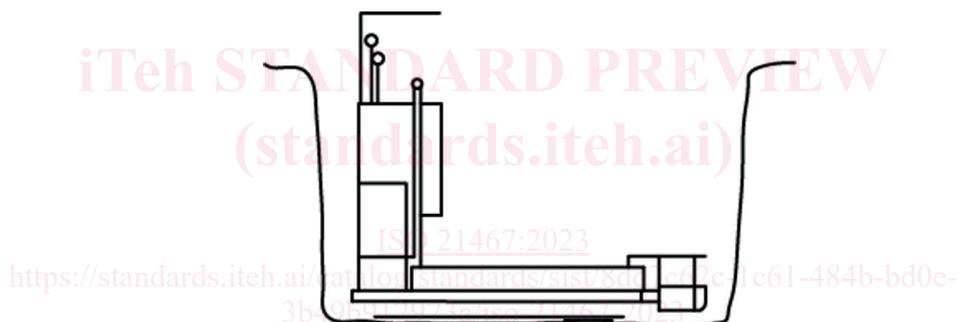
Exemple de machine HDD conçue pour travailler à partir d'un puits
